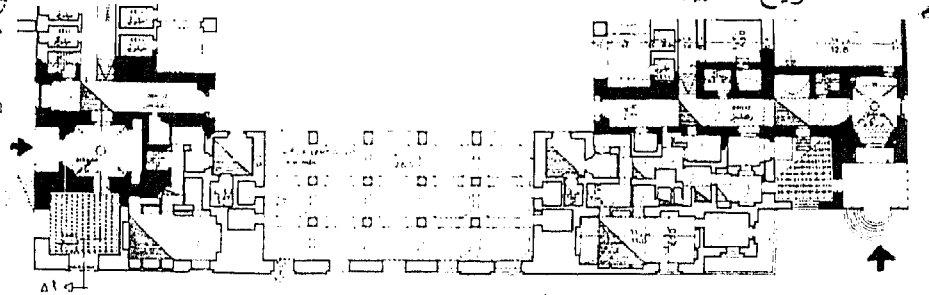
مسقط أفقي لمجموعة فرج بن برقوق
